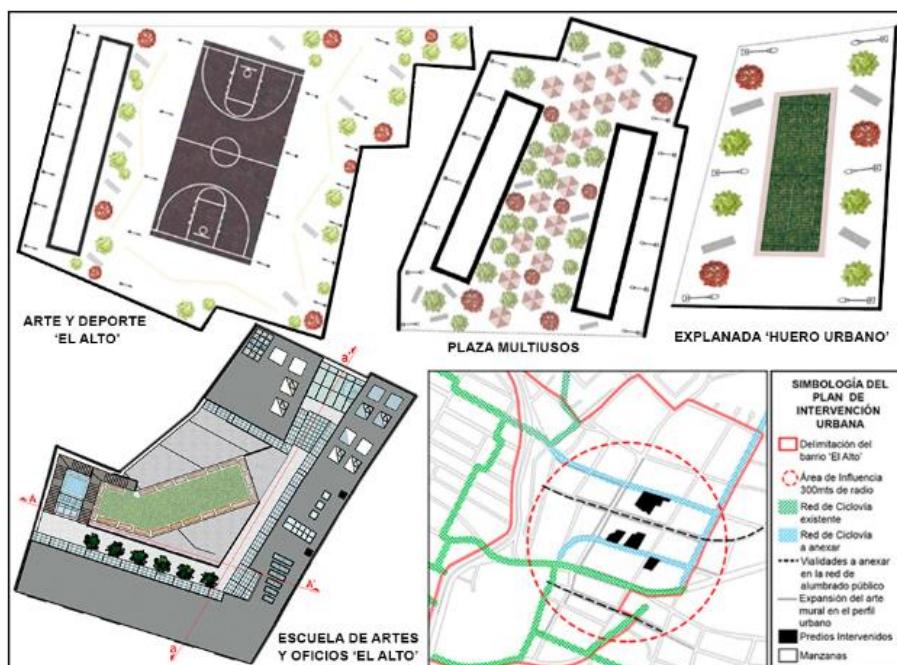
Plan de intervención urbana y plantas de conjunto de los proyectos propuestos
